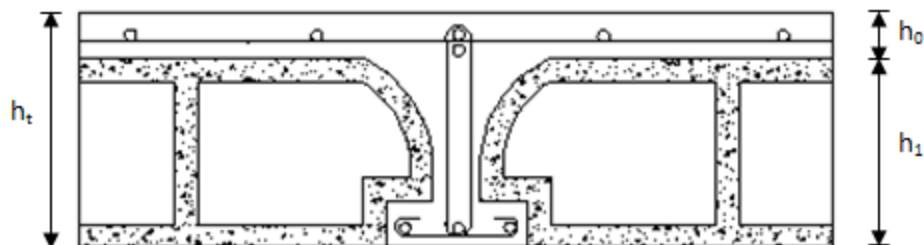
Coupe transversale d'un plancher à corps creux
